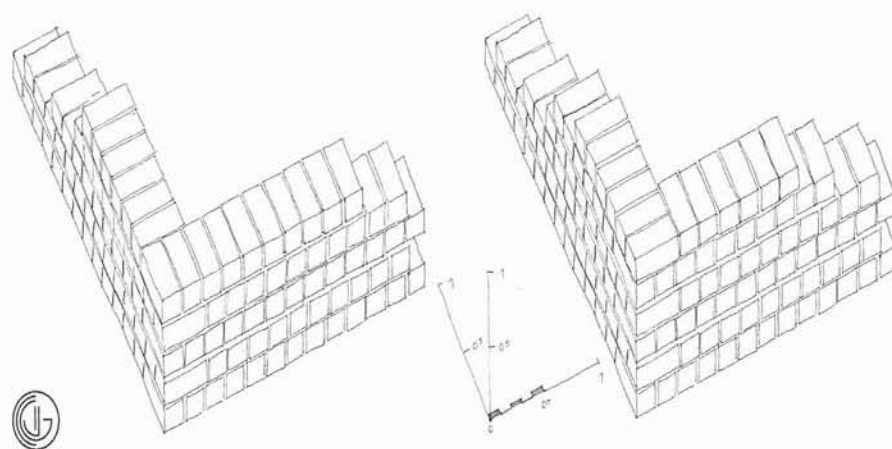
Proceso constructivo de un muro de adobe aparejado a tizón. Solución de la esquina
